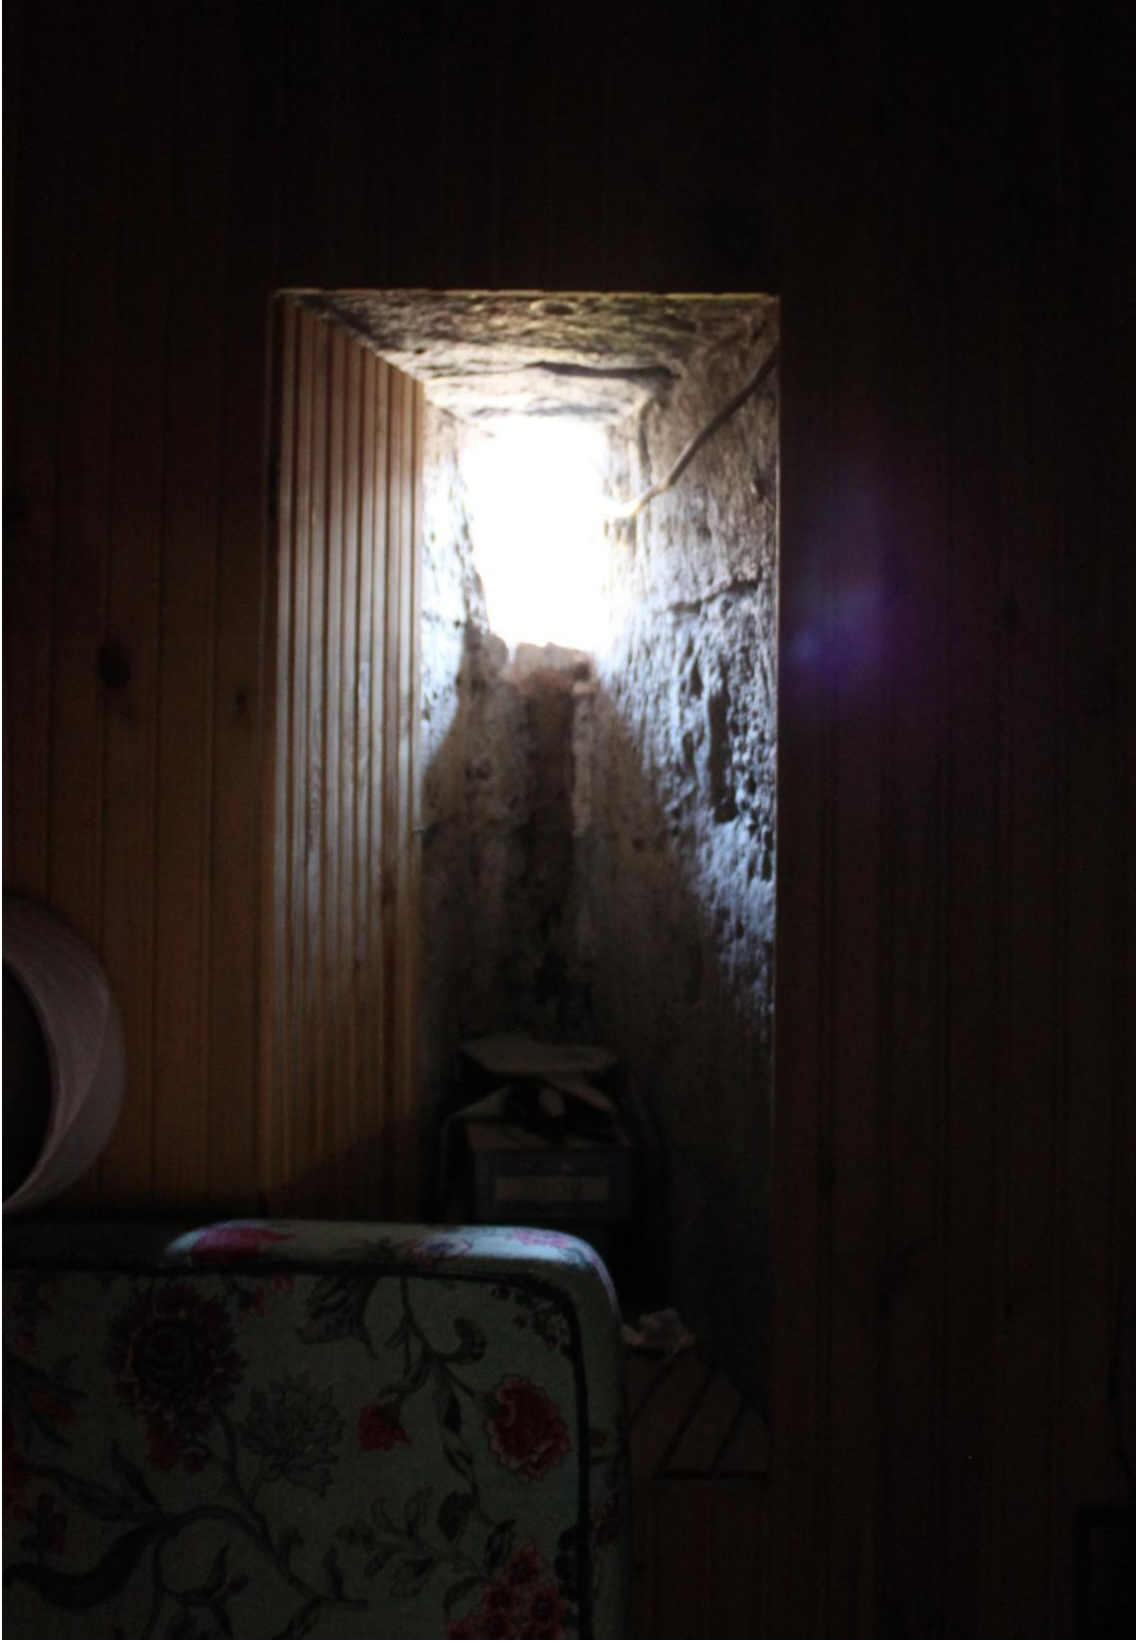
Rüstem Paşa Camii, Dolap 6
